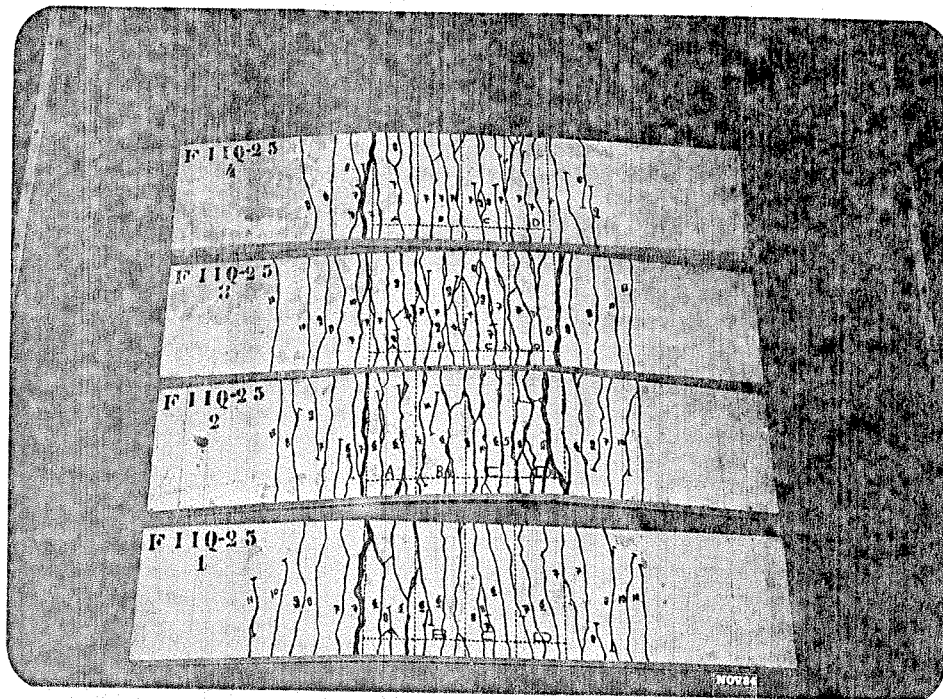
Fissuração final - SERIE F11Q25
